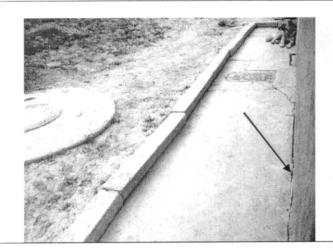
Se observan las Grietas en el piso de la vivienda donde habita la Sra. Martha Lebró.
